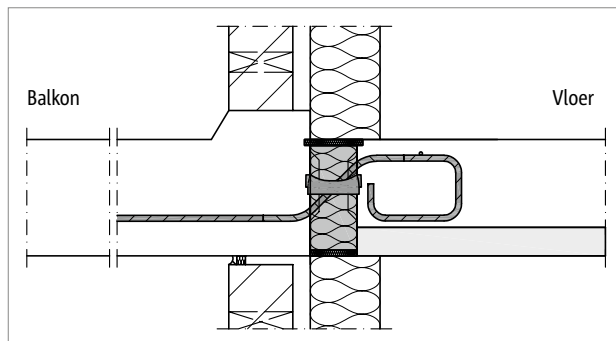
Schöck Isokorb® T type Q-E-Z, Q-E: Toepassingsvoorbeeld eenassig gespannen plaat van gewapend beton
